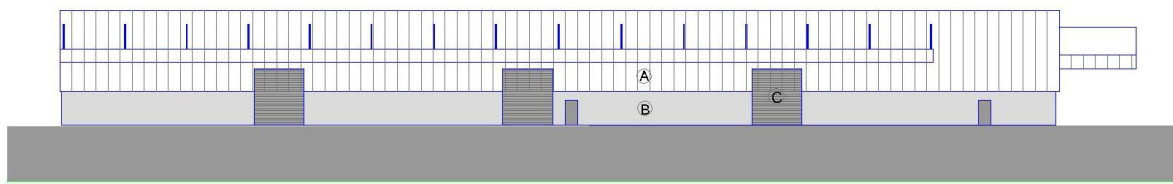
Alçado Sul do armazém: a) Chapa metálica, b) Portão em chapa metálica, c) Murete em betão.
